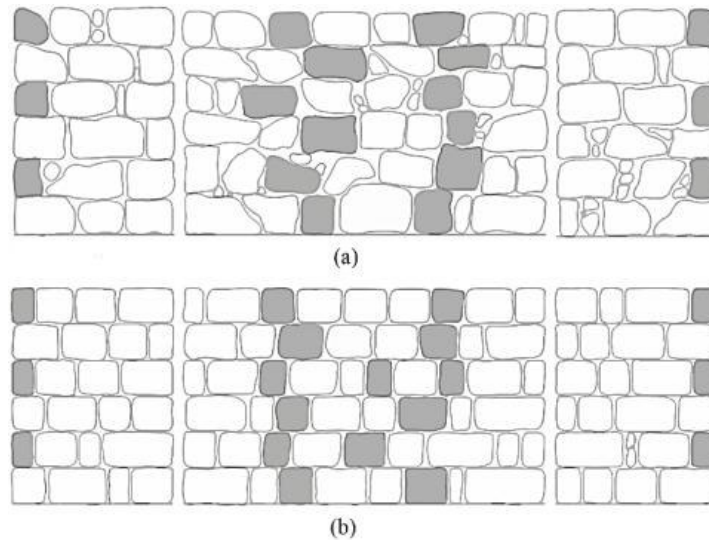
Elevación de muros que muestran dos tipos de construcciones: (a) construcción de mampostería irregular (b) construcción de mampostería regular (Adaptado de Maccarini et al., 2018).
